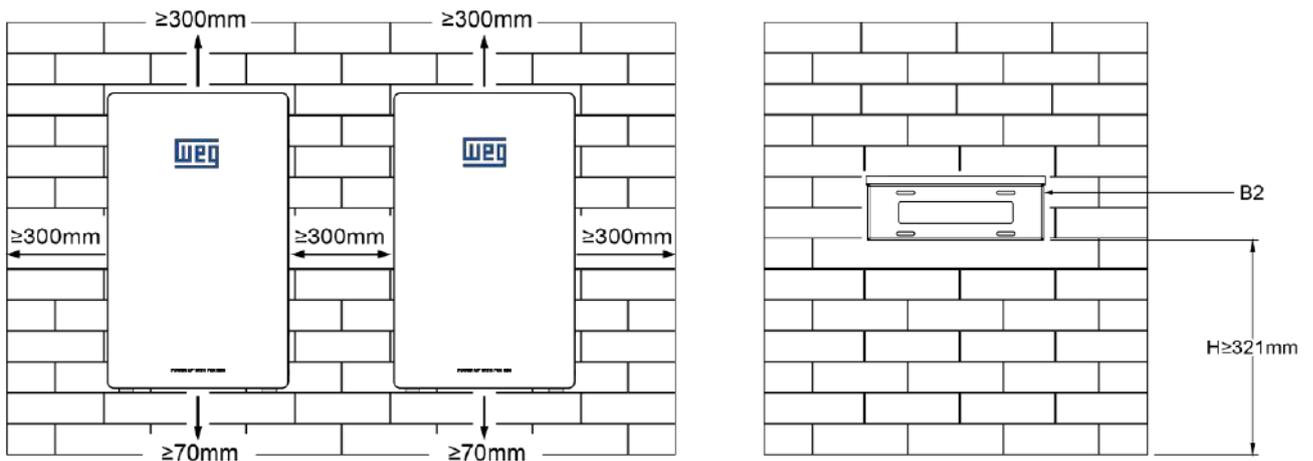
Espaçamento mínimo de instalação para montagem em parede.
